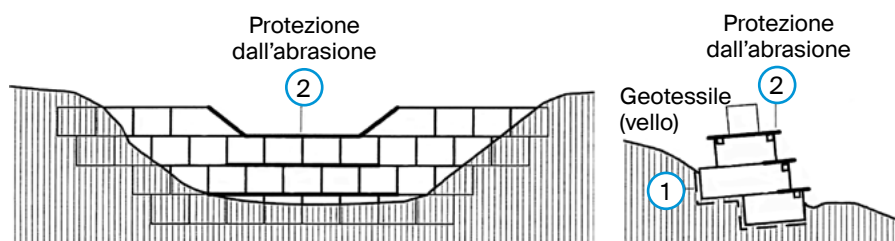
Briglia con gabbioni, variante B: prospetto e sezione (USTRA)
